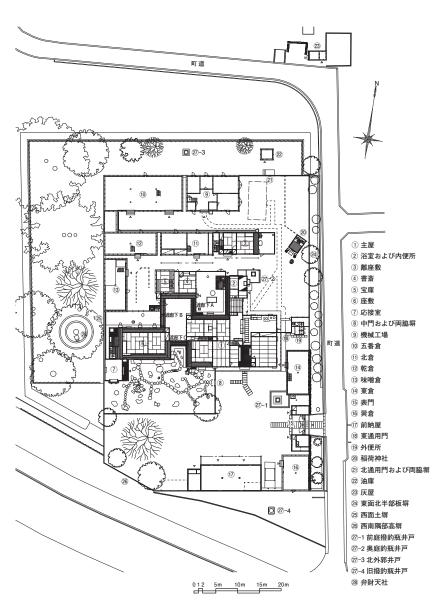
犬伏家住宅 1 階平面図(出典:参考文献1)
